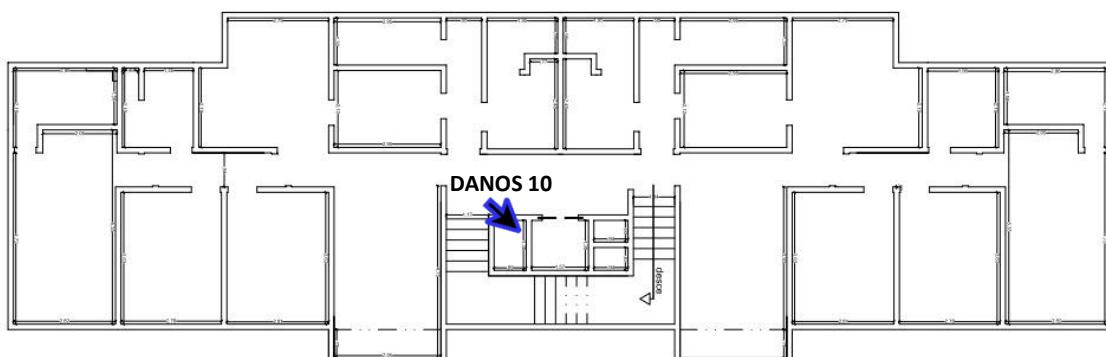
Planta Baixa (croqui) do Pavimento do 6º andar – Bloco C – Cond. Armando Lôbo.
